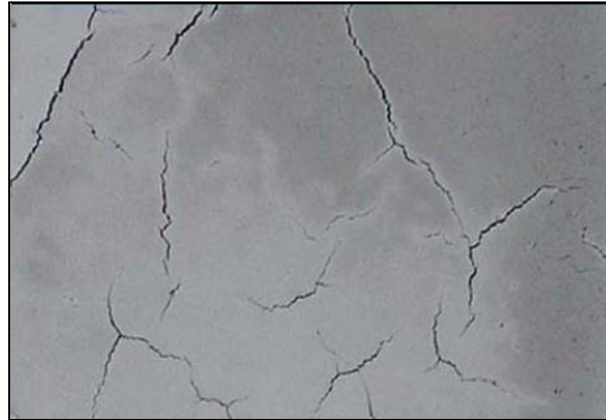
Façade altérée par le retrait (Parexlanko 2008).
